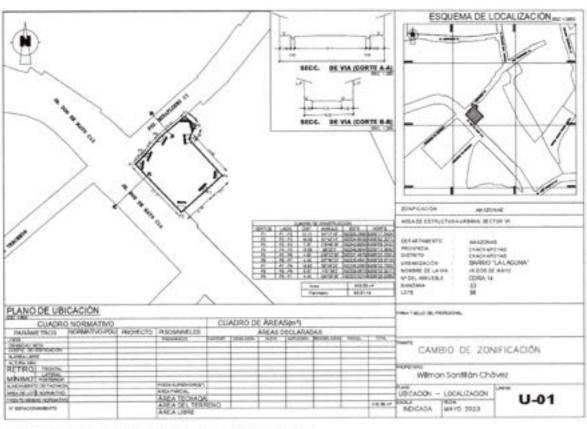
PLANO DE UBICACIÓN (Ver Anexo 01 Plano UL-01)
